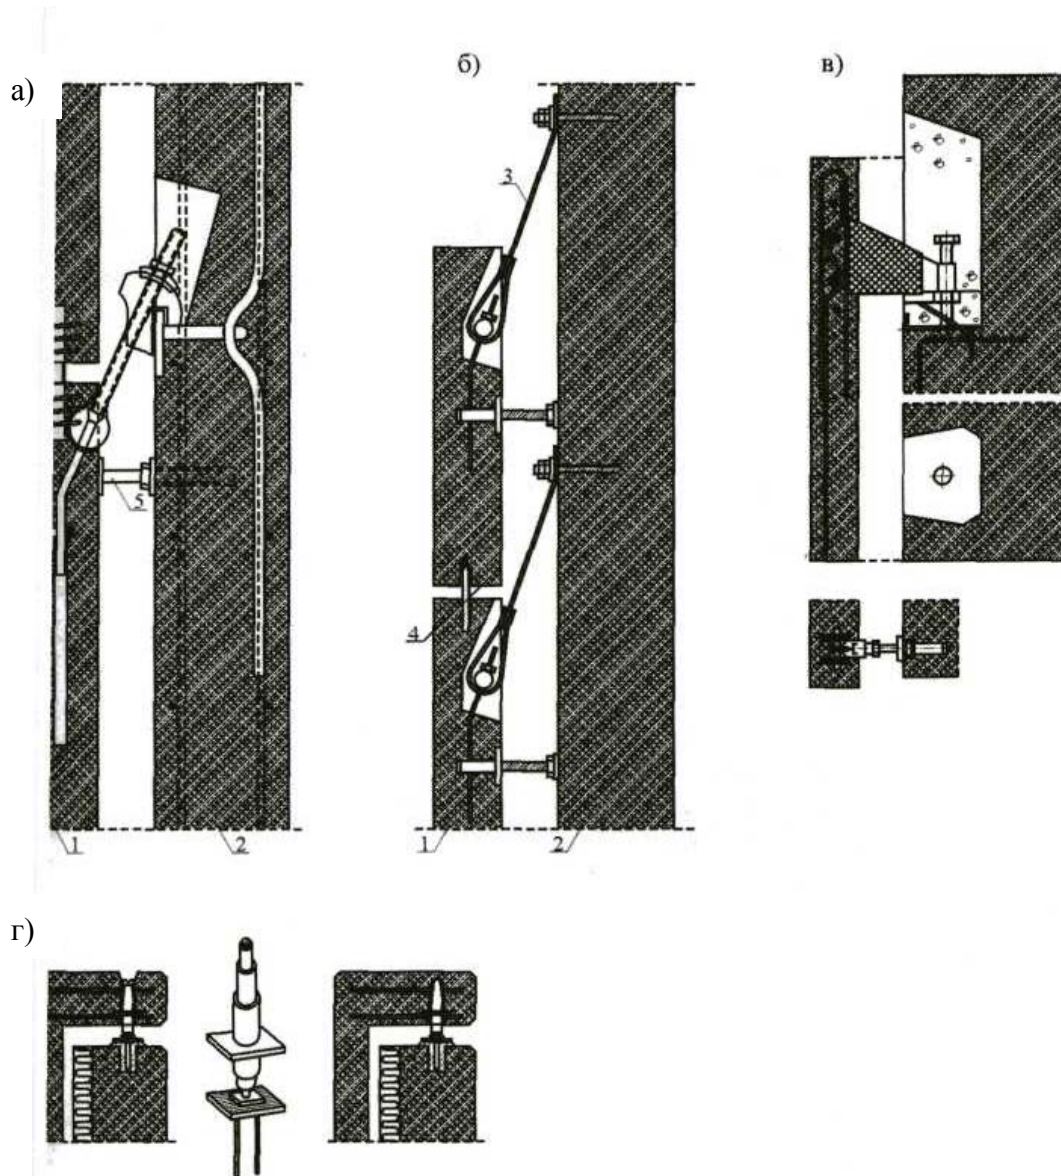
Варианты болтовых конструкции навески облицовочных бетонных плит наружных стен: а-в – варианты навески плоских плит (утеплитель условно не показан),
